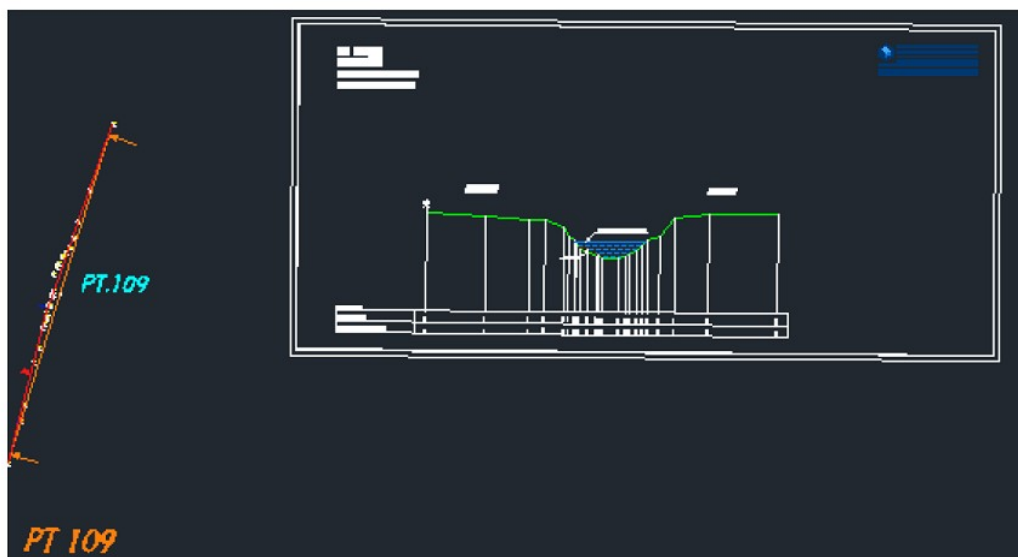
Exemple de fichiers Autocad contenant les profils en travers géomètres géo-référencés.
